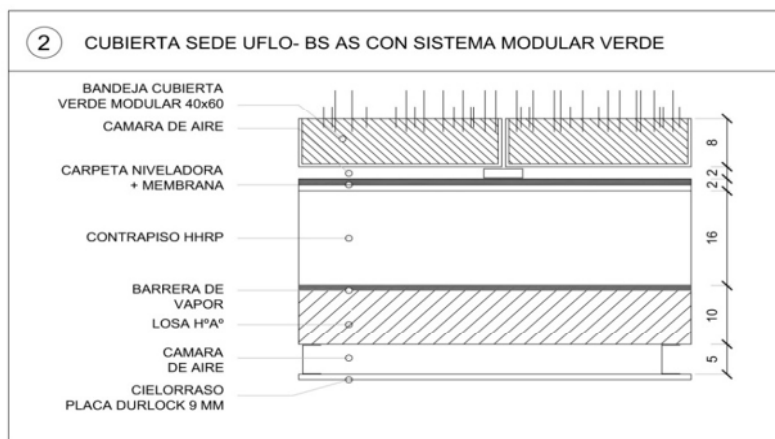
corte constructivo de la cubierta con sistema de bandejas verdes incorporado.
